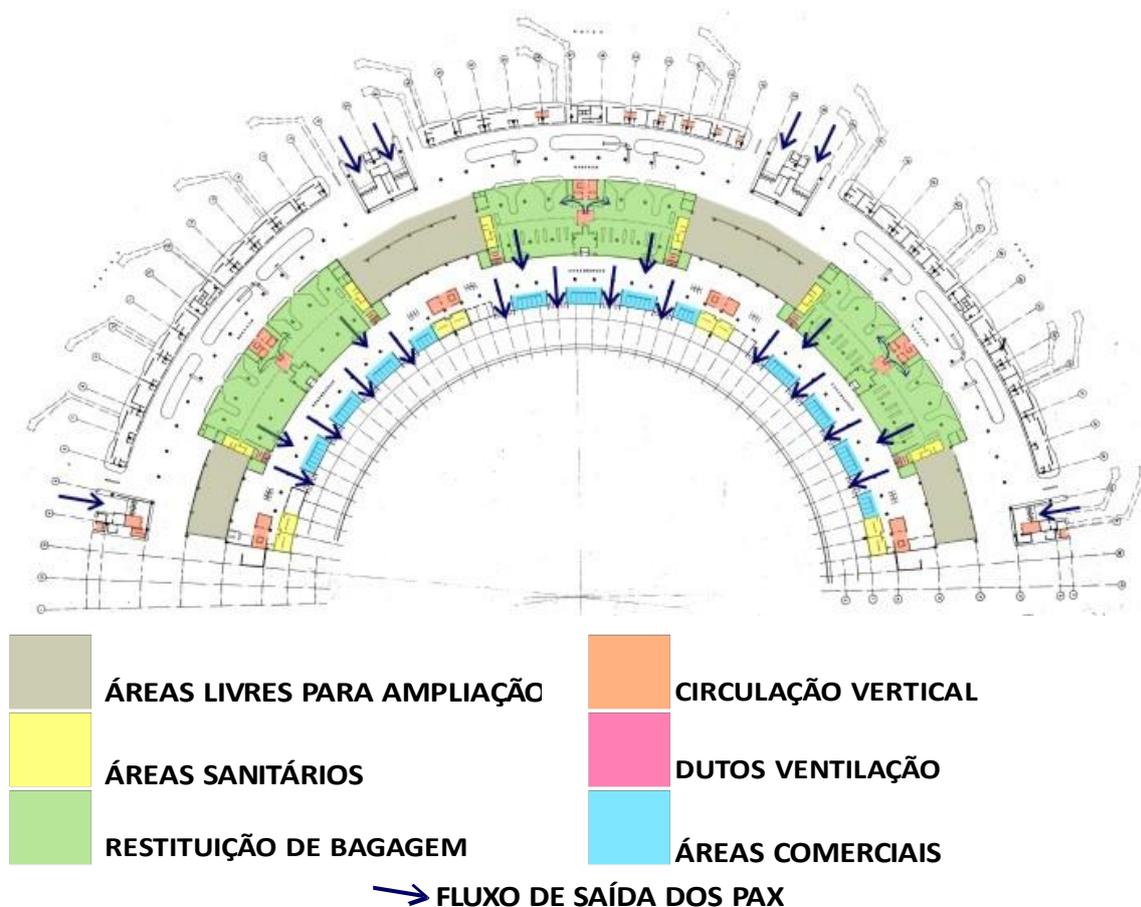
Pavimento de Desembarque em 1984 aproximadamente.
